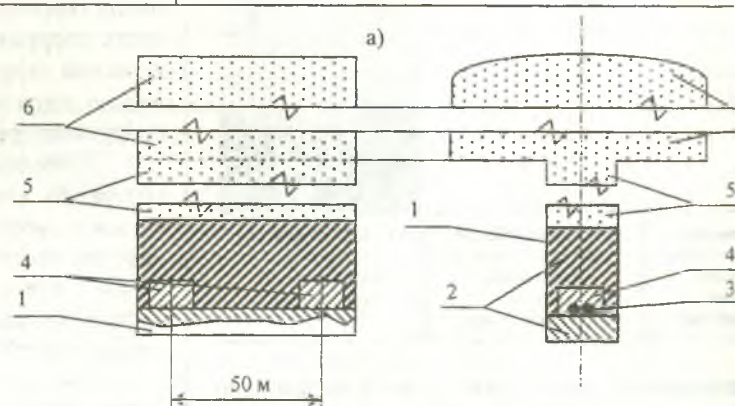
Способ формирования конструкции обвалованного грунтом траншейного заряда ВВ на выброс в водонасыщенных грунтах (а – продольный, б – поперечный разрез траншеи)
